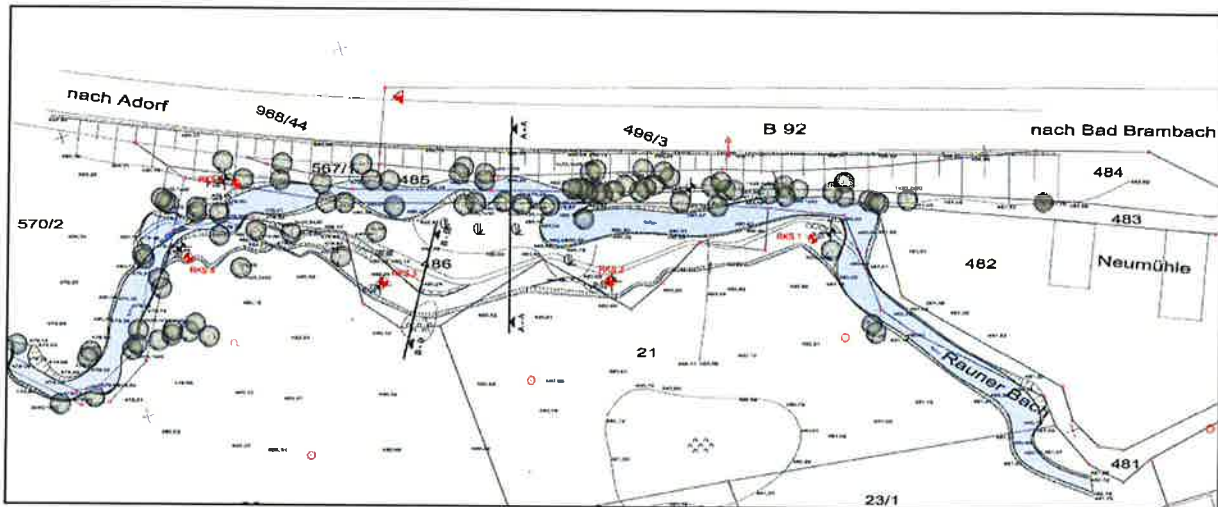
Ausschnitt Lageplan Aufschlusspunkte mit Darstellung der RKS 1 - 5 (rot) (aus Anlage 6.1, [ECK-19])
